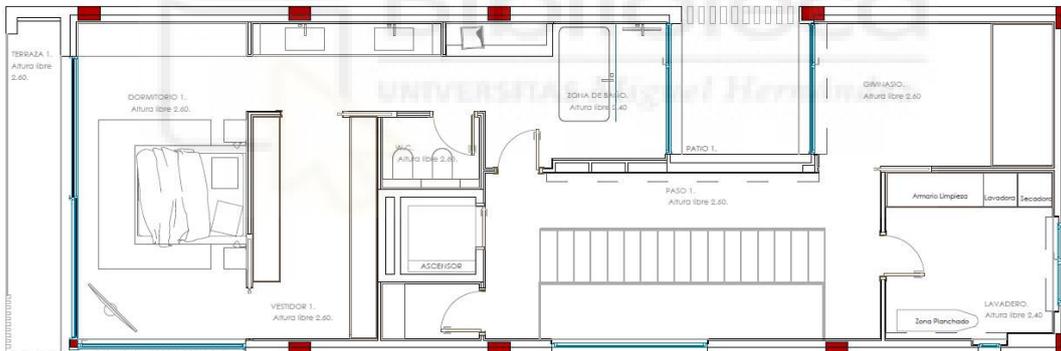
Plano de la Planta Primera de la vivienda. Vista: En Planta
